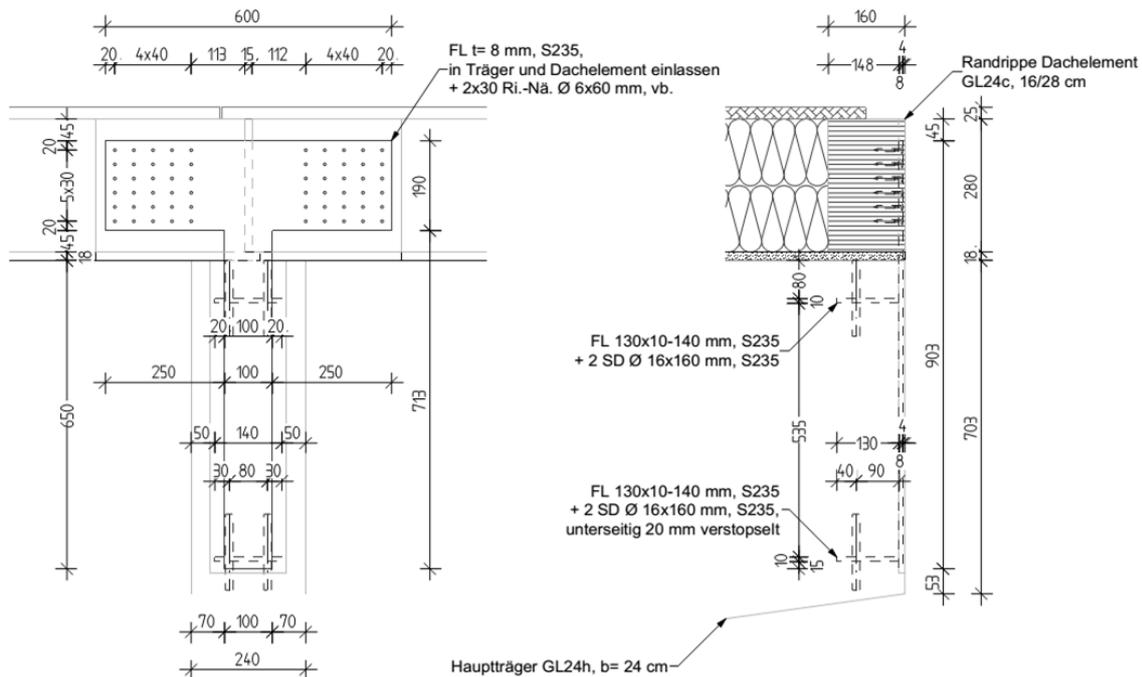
Detail zur horizontalen Halterung des Trägerendes, Werkstattplanung Holzbau Grossmann Bau GmbH & Co. KG
